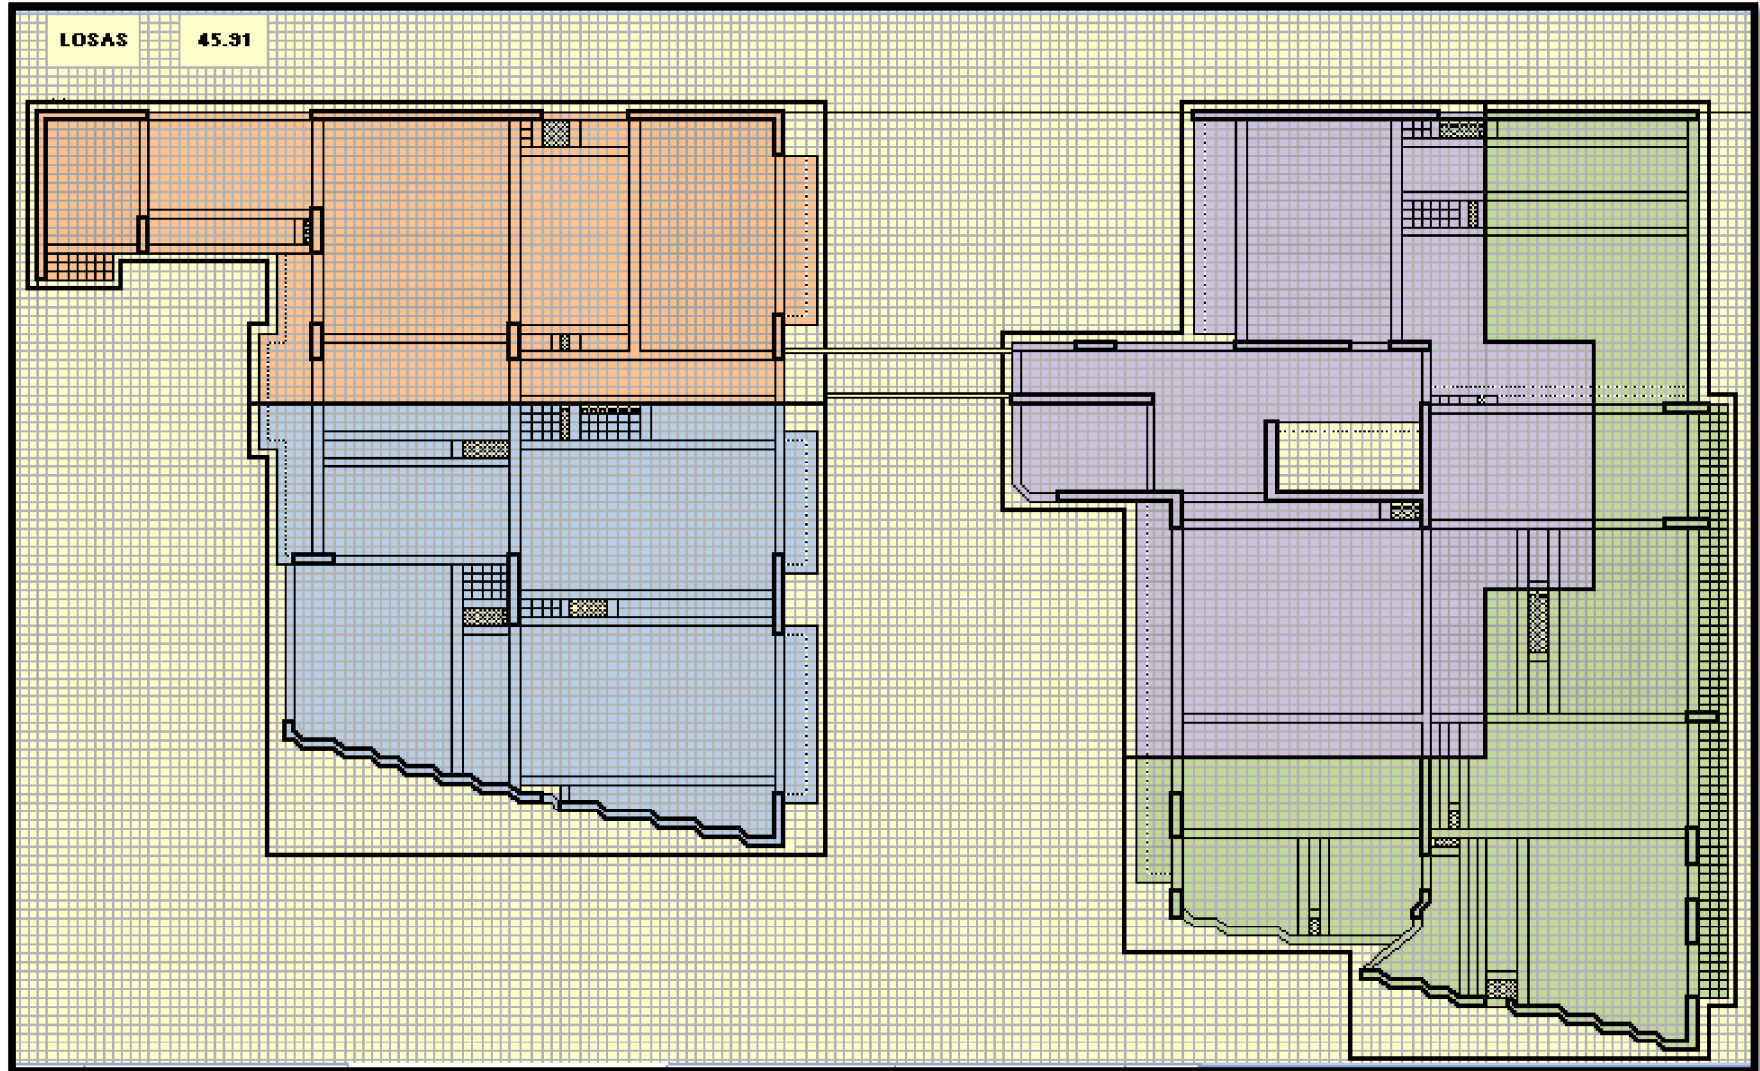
Sectorización de la planta típica en 4 (Fuente: Edifica)
